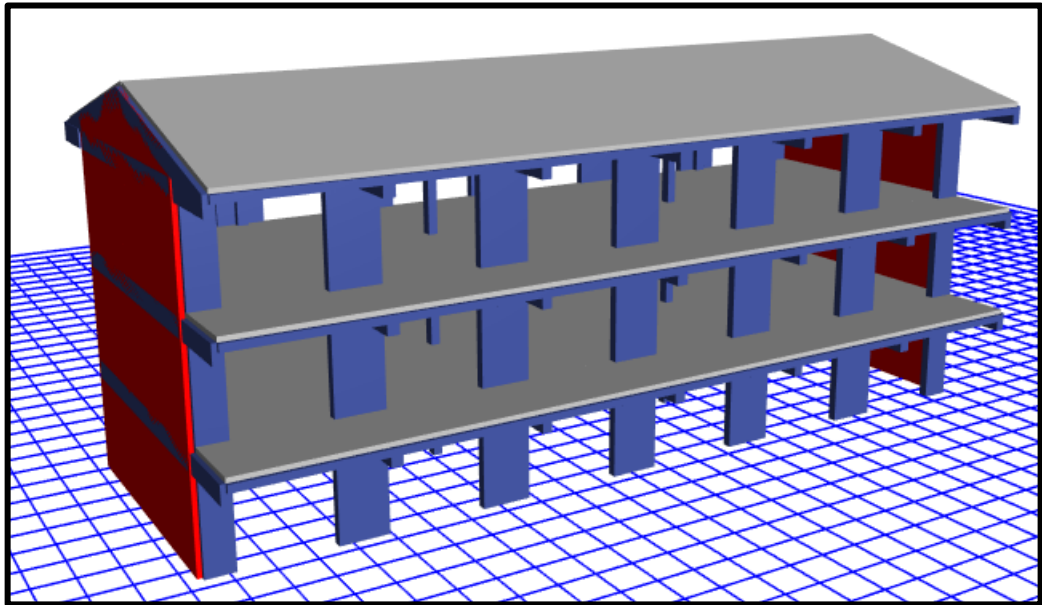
Vista de elementos estructurales en 3D Renderizado.
